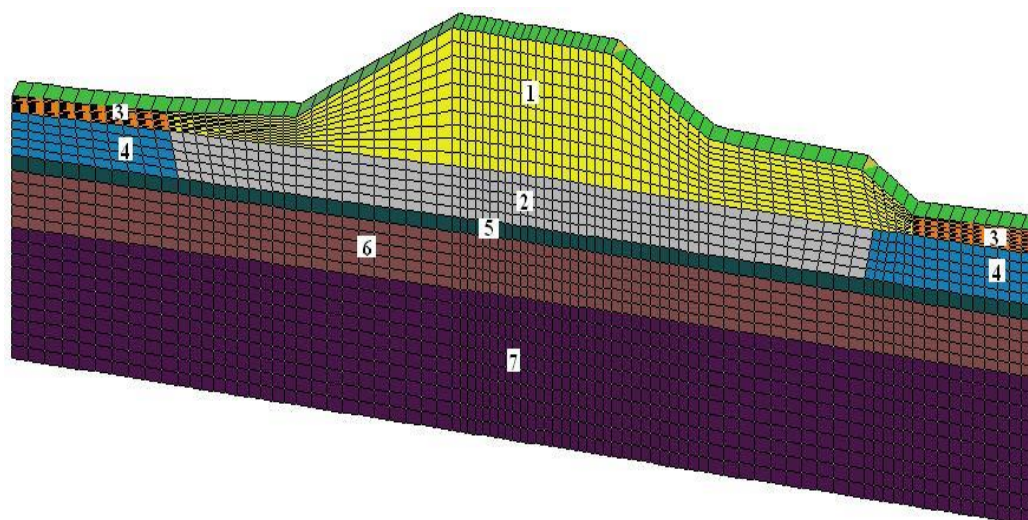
Расчетная схема поперечного профиля железнодорожной насыпи. Цветом показаны разные виды грунта (разработано авторами)
